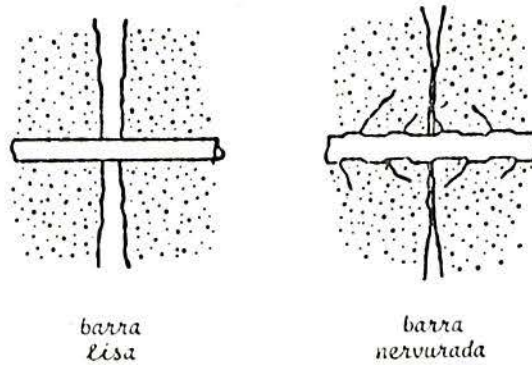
Fissuras para diferentes tipos de barras
